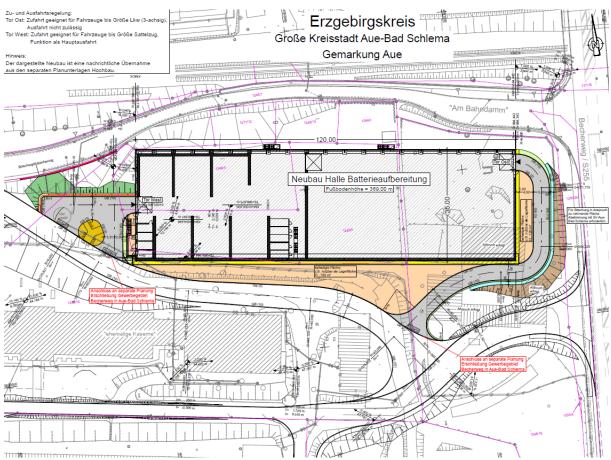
Auszug Lageplan Außenanlagen mit Darstellung geplante Halle Auszug Genehmigungsantrag vom 02.03.2023
